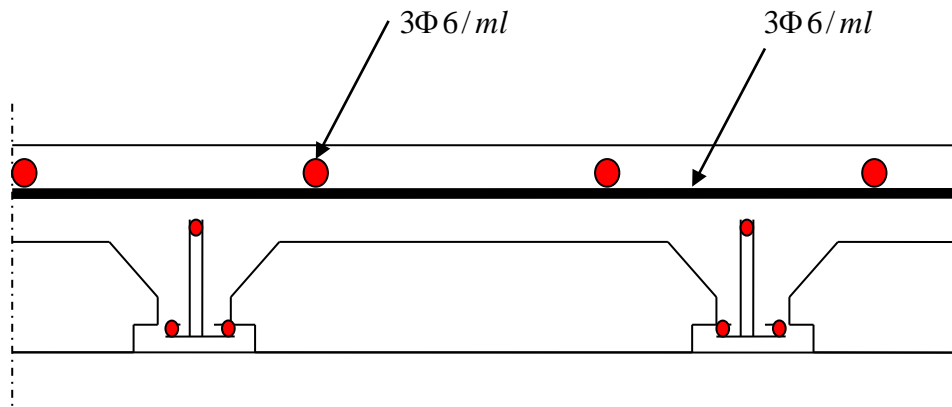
Schéma de ferrailage de la dalle de compression.
